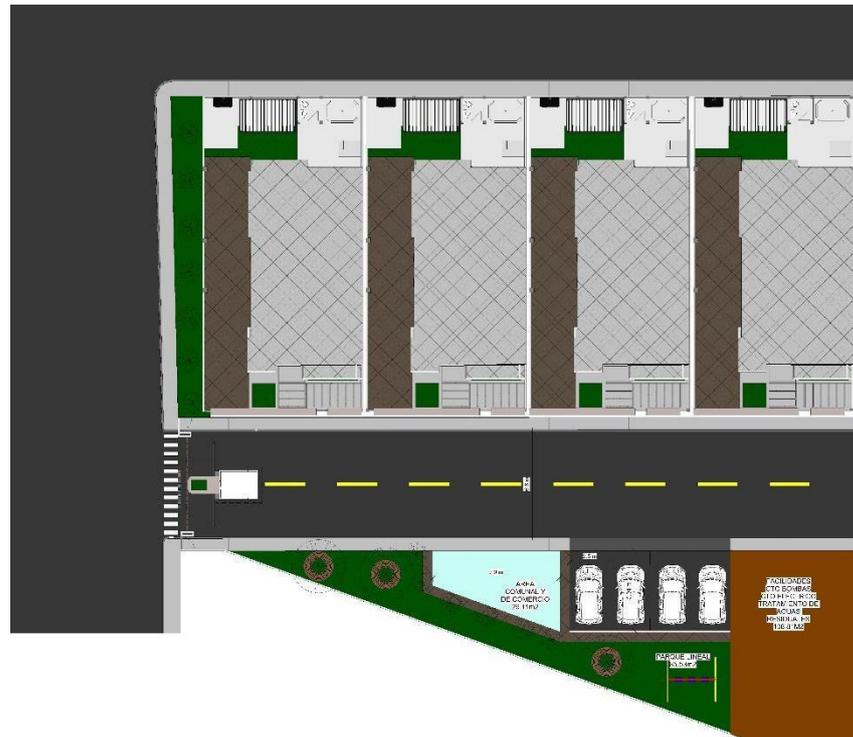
Vista en planta del plan masa de la urbanización propuesta. (Elaboración propia archivo RVT).
